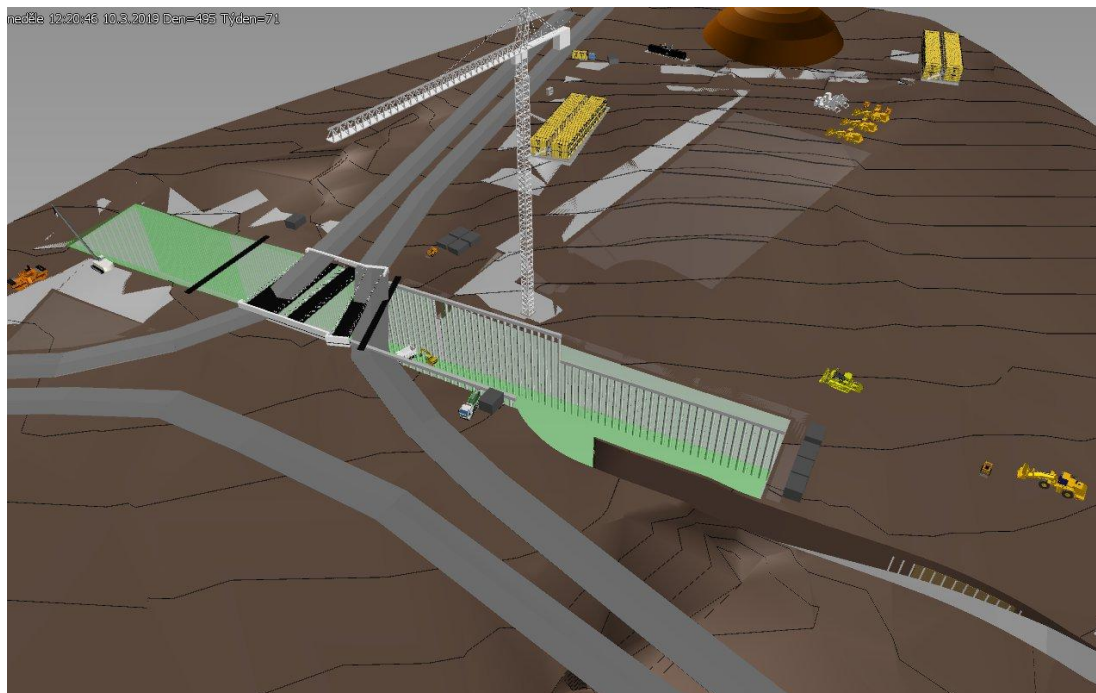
Vybudovaná rampa a přemostění, výstavba zajištění stavební jámy pilotami
